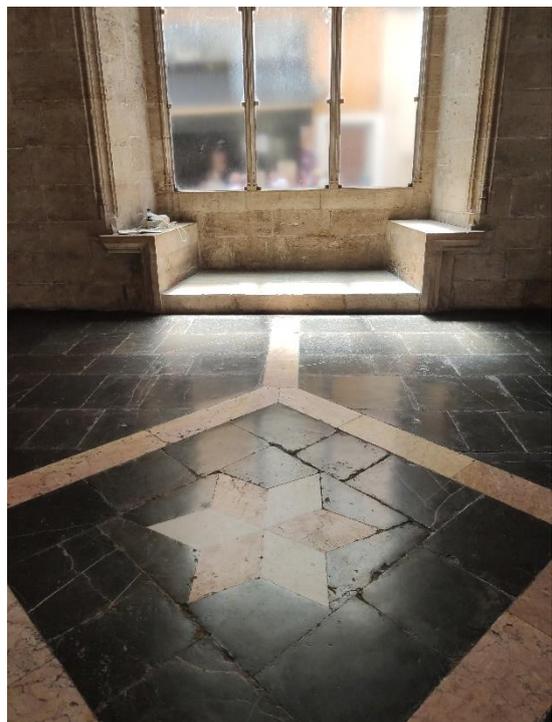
Encuentro del pavimento con las ventanas de la sala de mercaderías de la Lonja.
